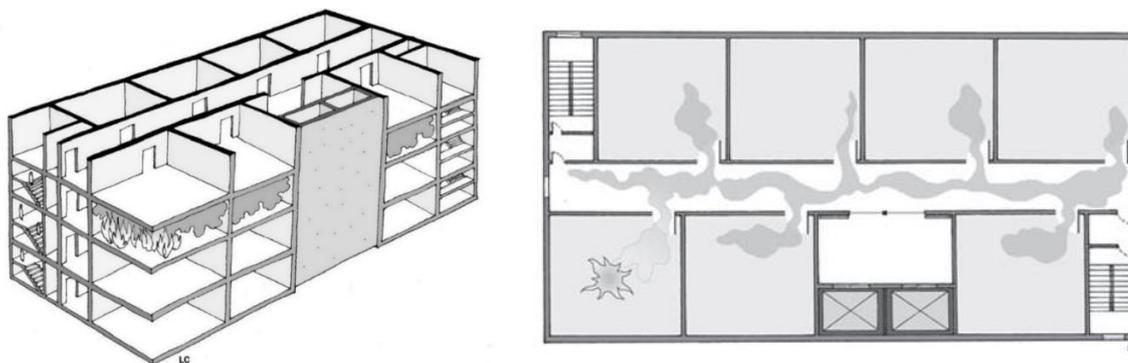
Compartimentação vertical entre pavimentos (escadas e elevadores) [73]
